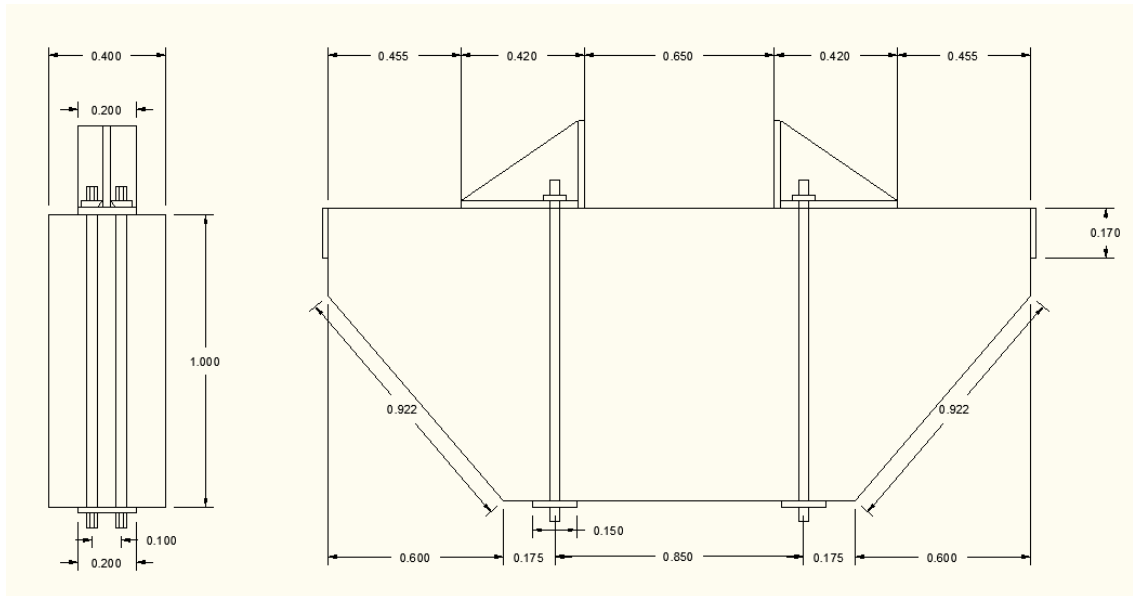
Definição da geometria final do bloco e posição das peças metálicas e ancoragens
